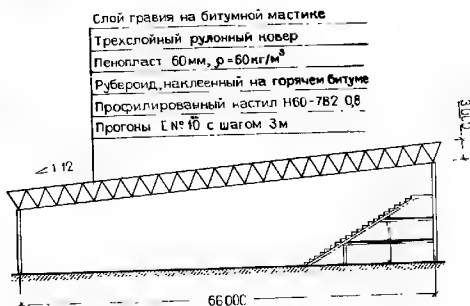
Поперечный разрез спортивно-демонстрационного зала, перекрытого стержневой плитой из пентаэдров (пример)
